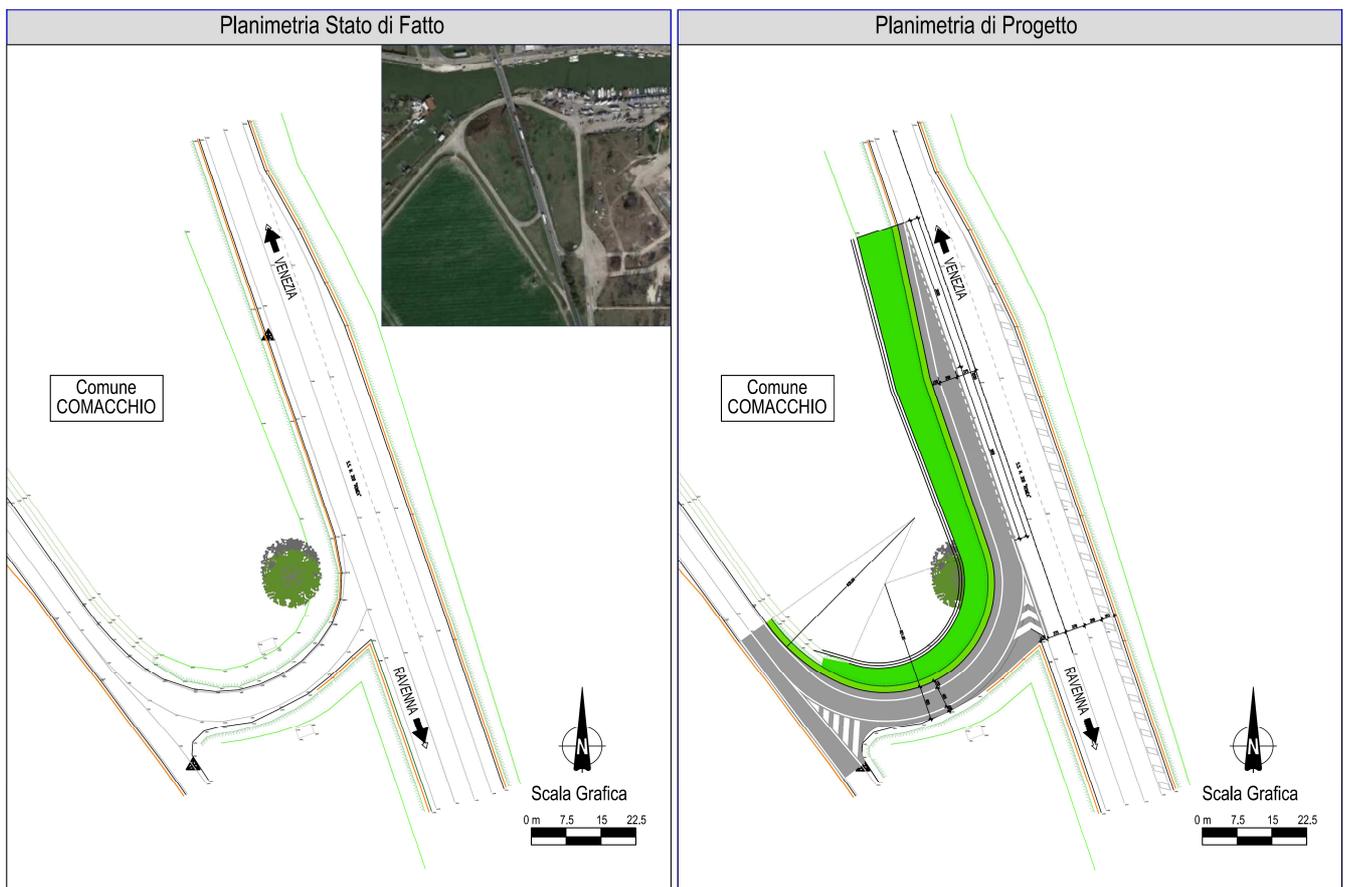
Intervento n°7 – Planimetria Stato di fatto - Progetto
